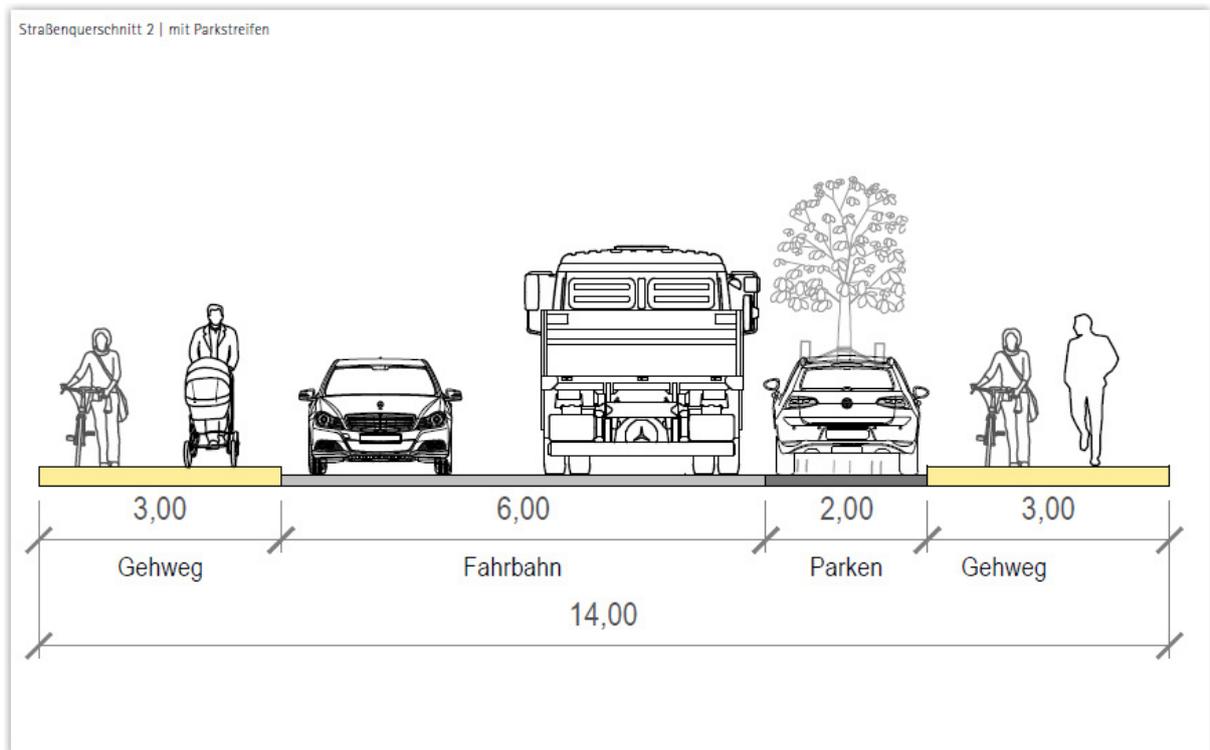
Straßenquerschnitt 2 innerhalb des Plangebiets (mit Parkstreifen) | Prinzip-Skizze
